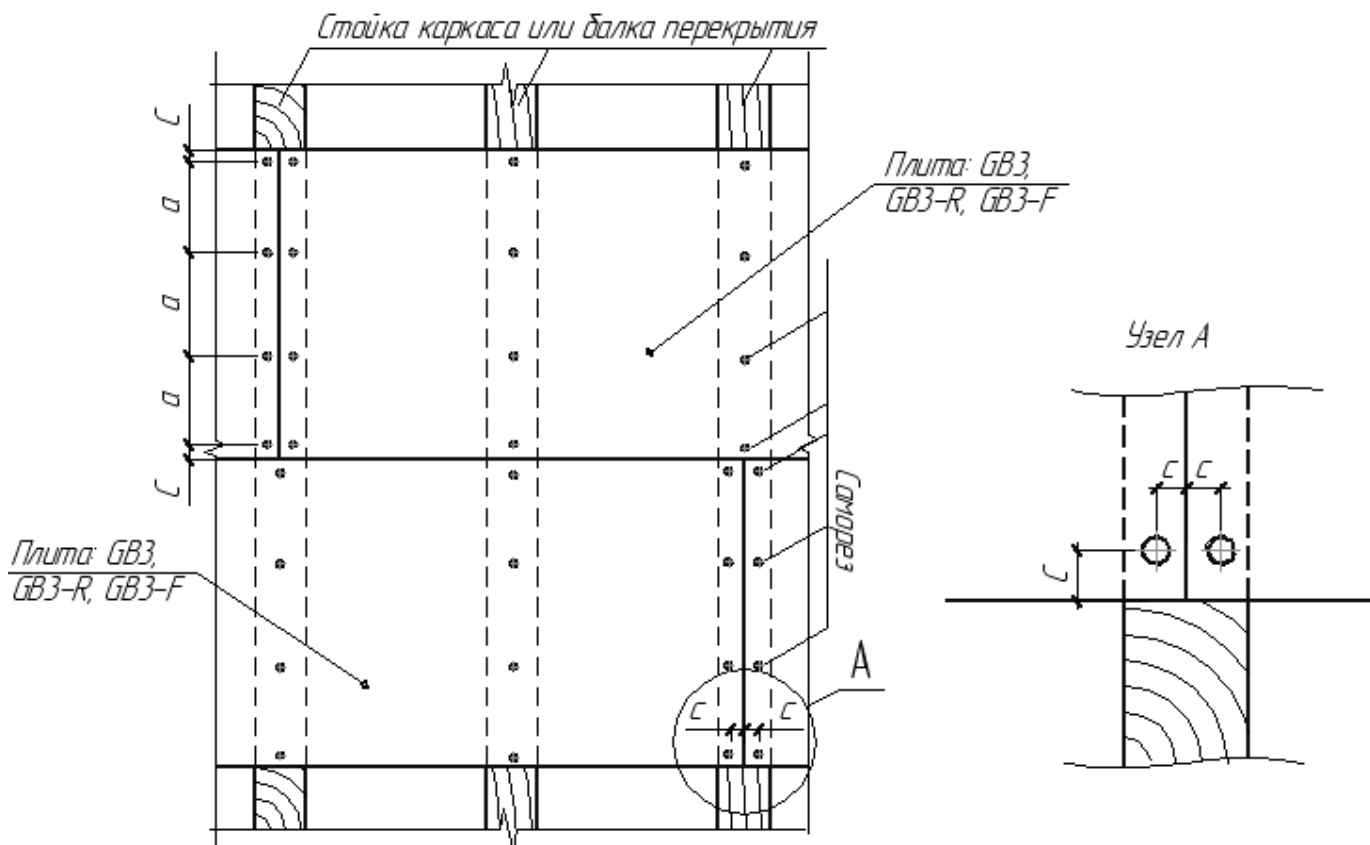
Крепление плит GB3 к каркасу перпендикулярно относительно или стоек каркаса или балок перекрытия
